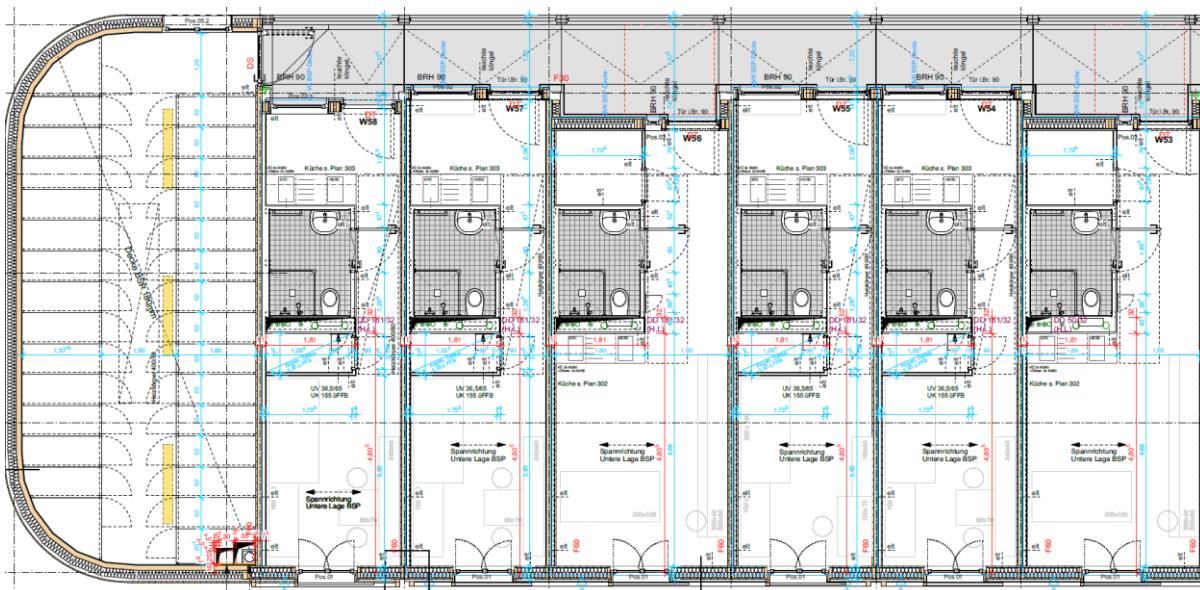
Wohnen am Dantebad I, Regelgrundriss
